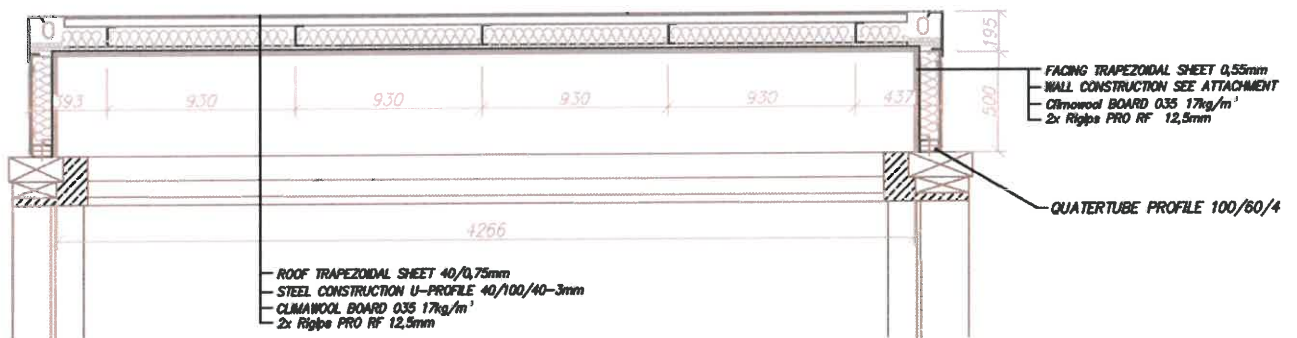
Längsschnitt des konstruktiven Aufbaus der Containerkonstruktion (Dachdecke)
